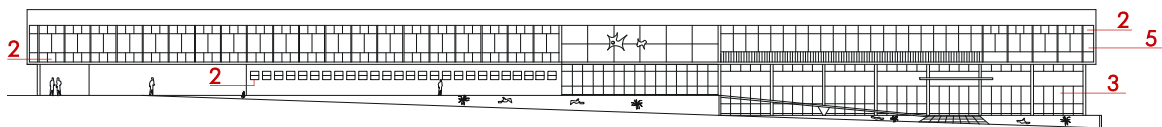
Elevação principal da rua Virgílio Malta: SENAI.
